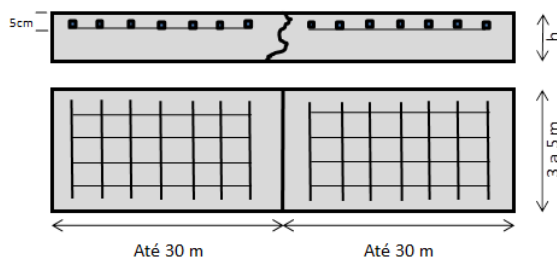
Pavimento de concreto com armadura contínua sem função estrutural
